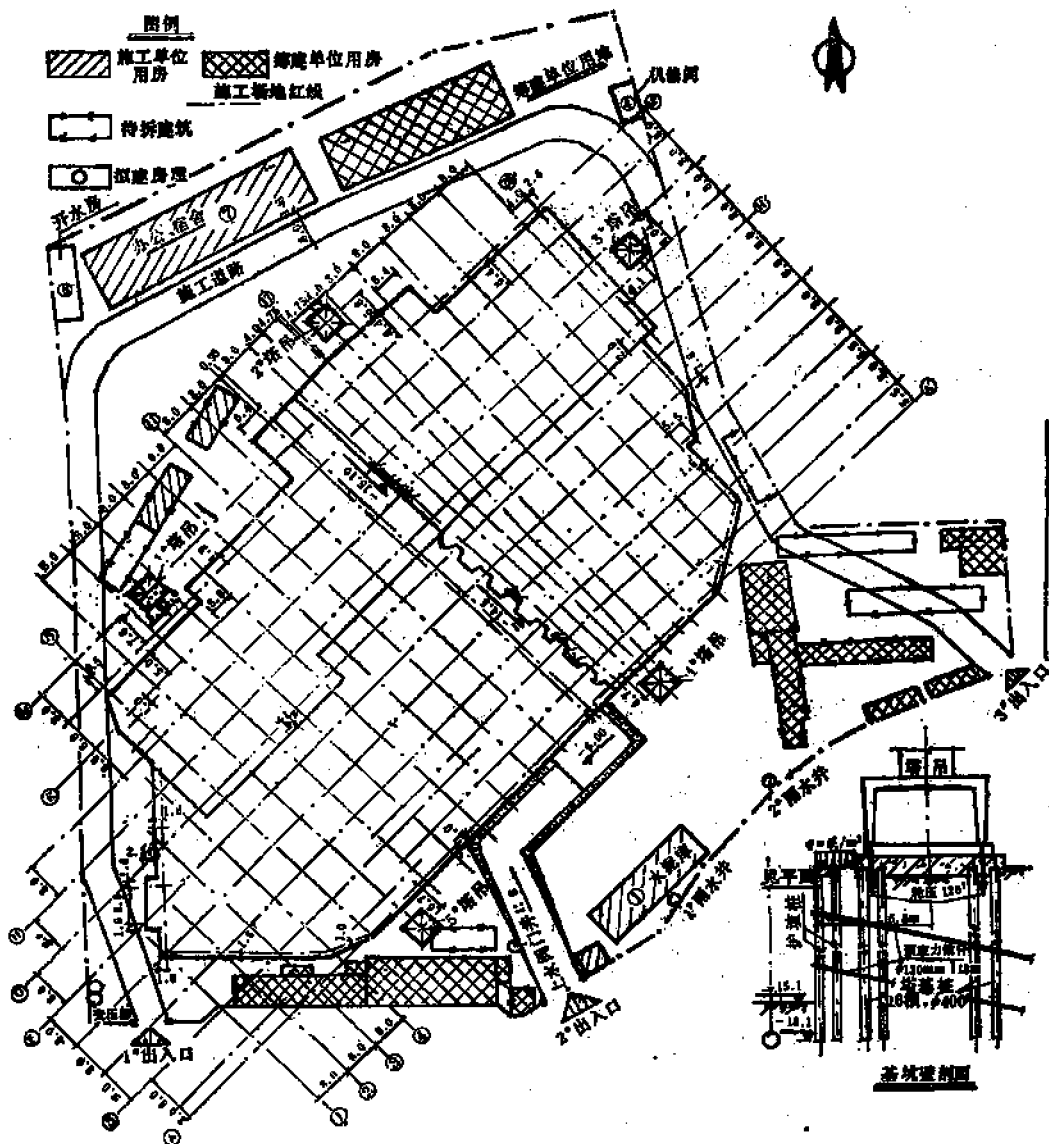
(5) 北京城乡贸易中心工程土方开挖平面图
